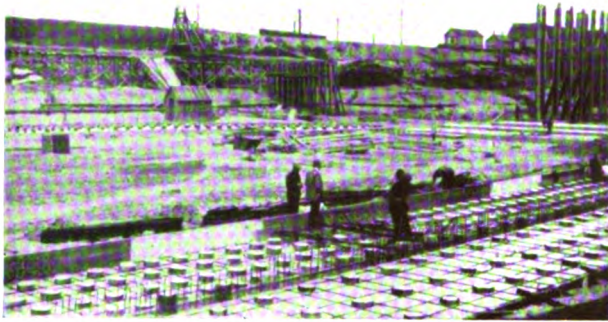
Betonierung des Eisenbetonrostes für die Kammer-TWL mauern in der trockengelegten Baugrube.
